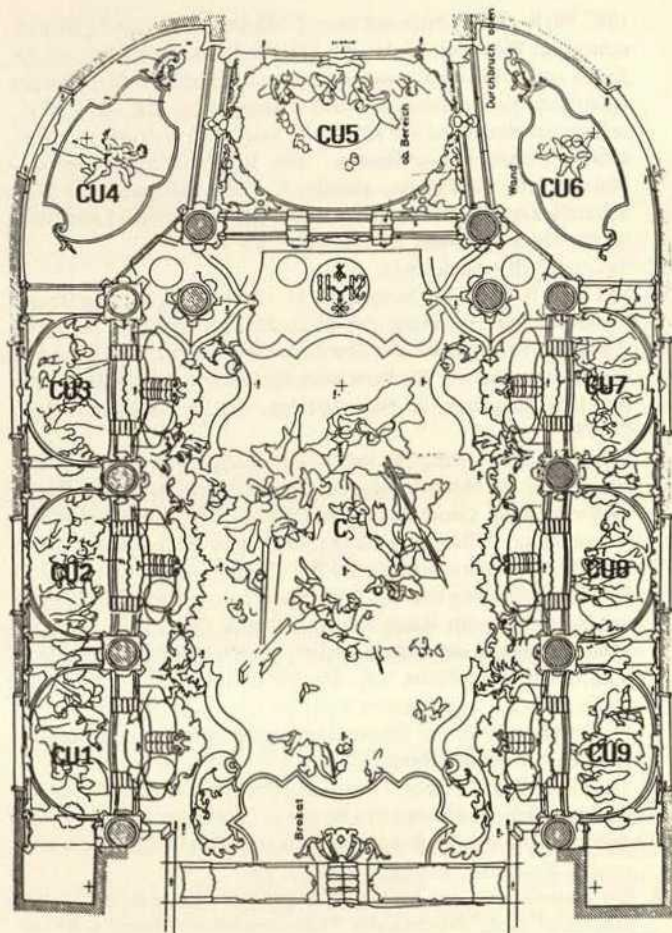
Gewölbeplan des Chores; photogrammetrische Auswertung mit Bezeichnung der Raumsegmente (C=Chor, CU=Chorumgang)
